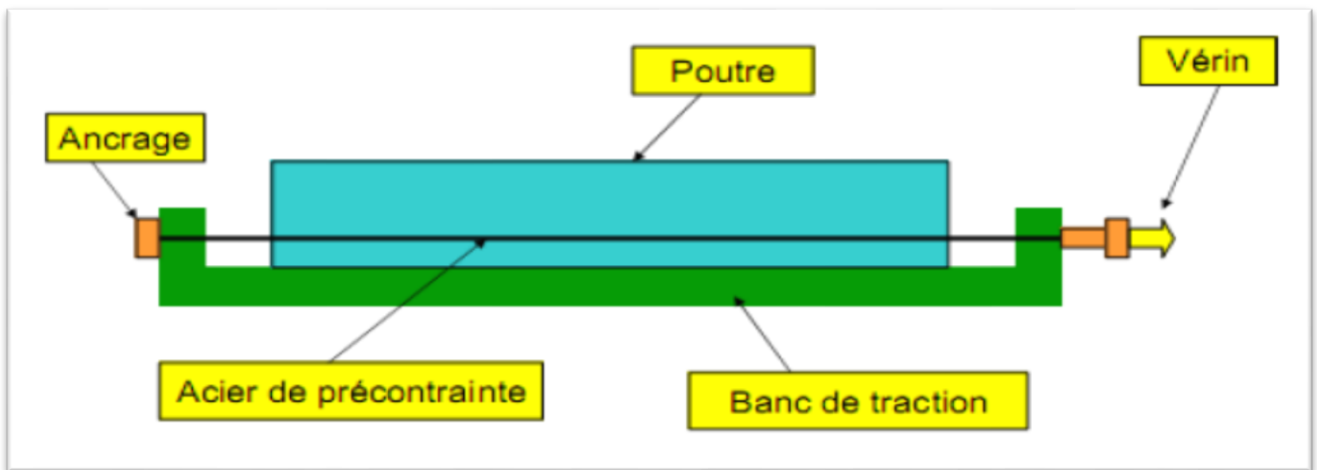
coupe longitudinale d'une poutre en béton précontraint [1]
